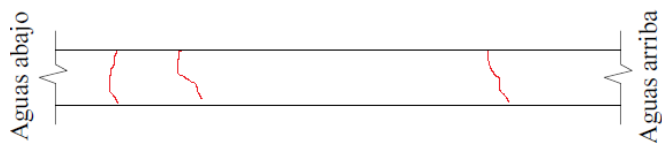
Ubicación de fisuras en Viga 4.3
